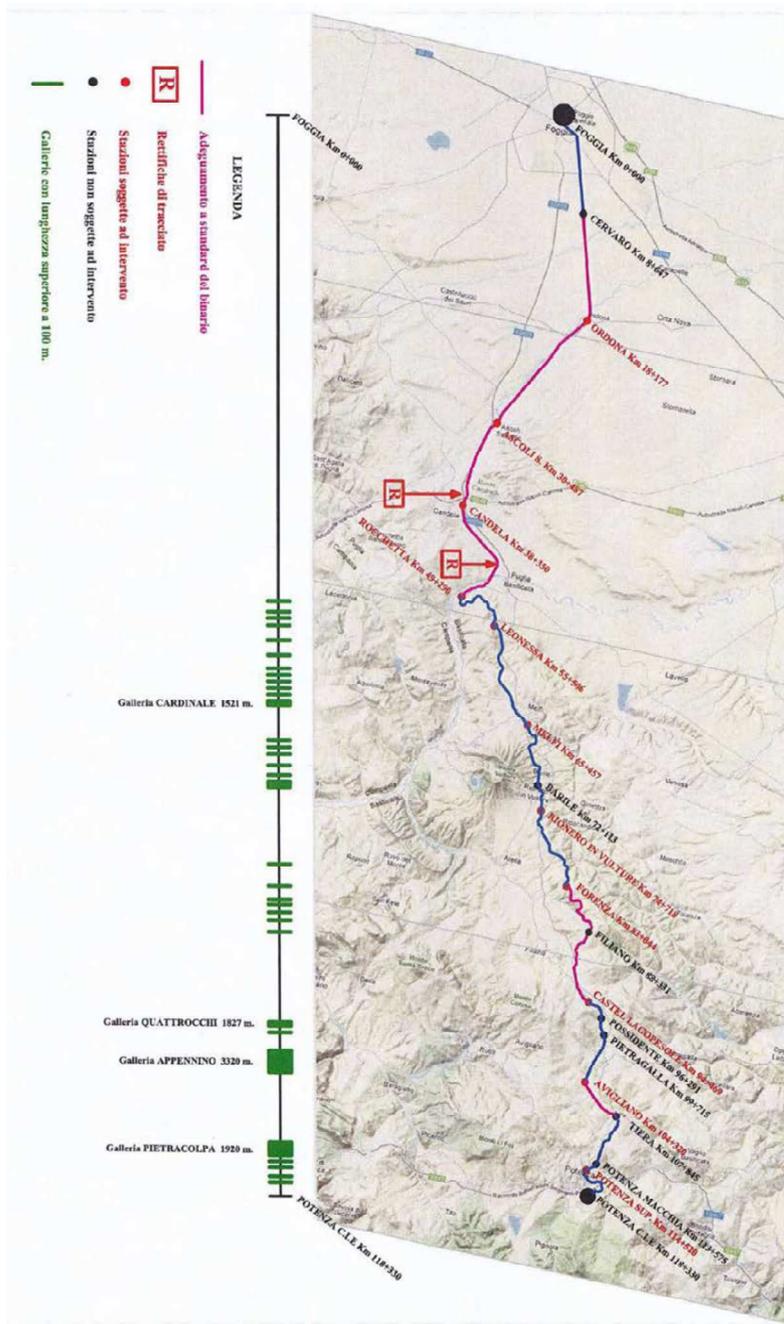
Planimetria della linea Ferroviaria Foggia-Potenza e localizzazione degli interventi
